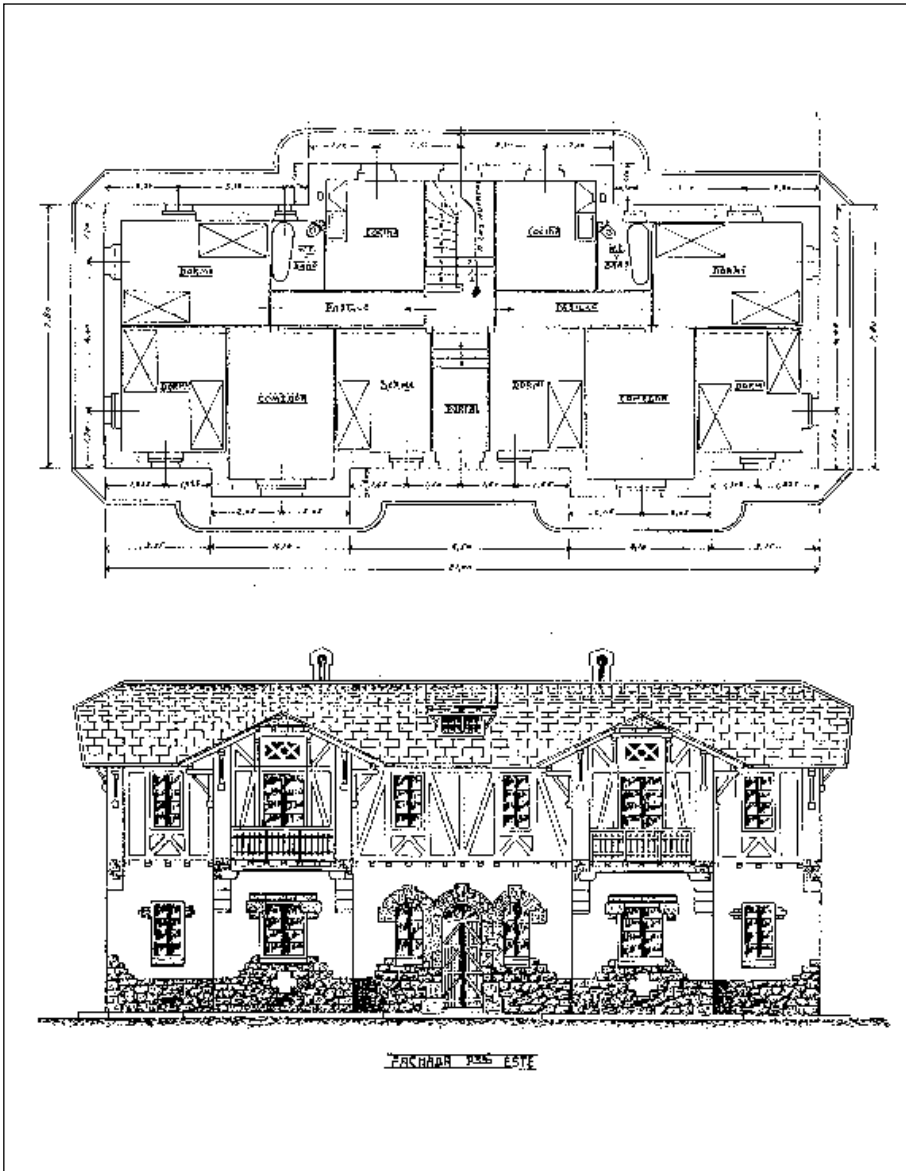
Planos de la villa B. Arquitecto José Ángel Fernández de Casadevante.
